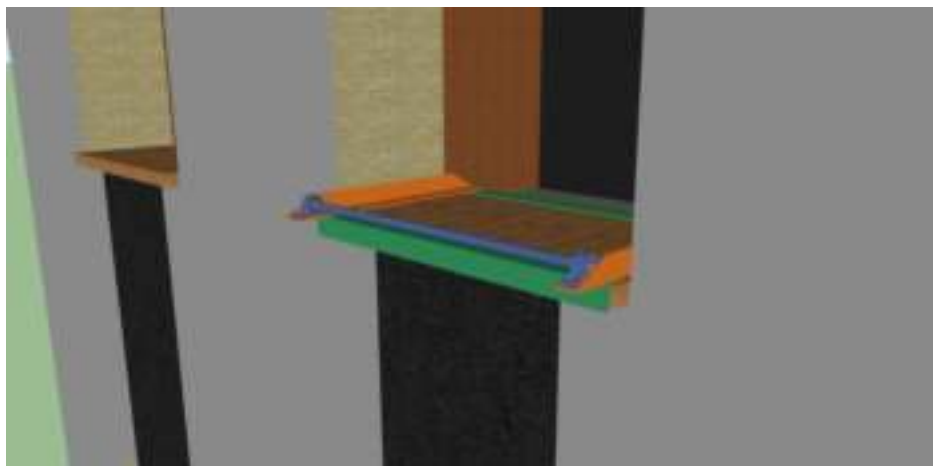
Расположение устройства (конструкции) – вид снаружи
